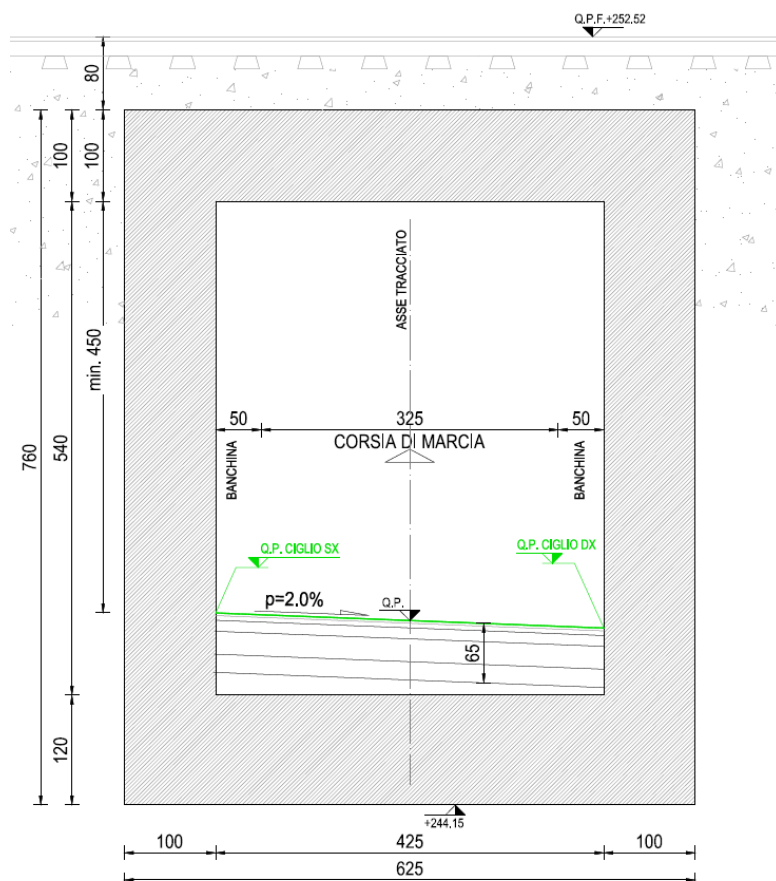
Sezione tipo sottopasso stradale Via San Francesco
